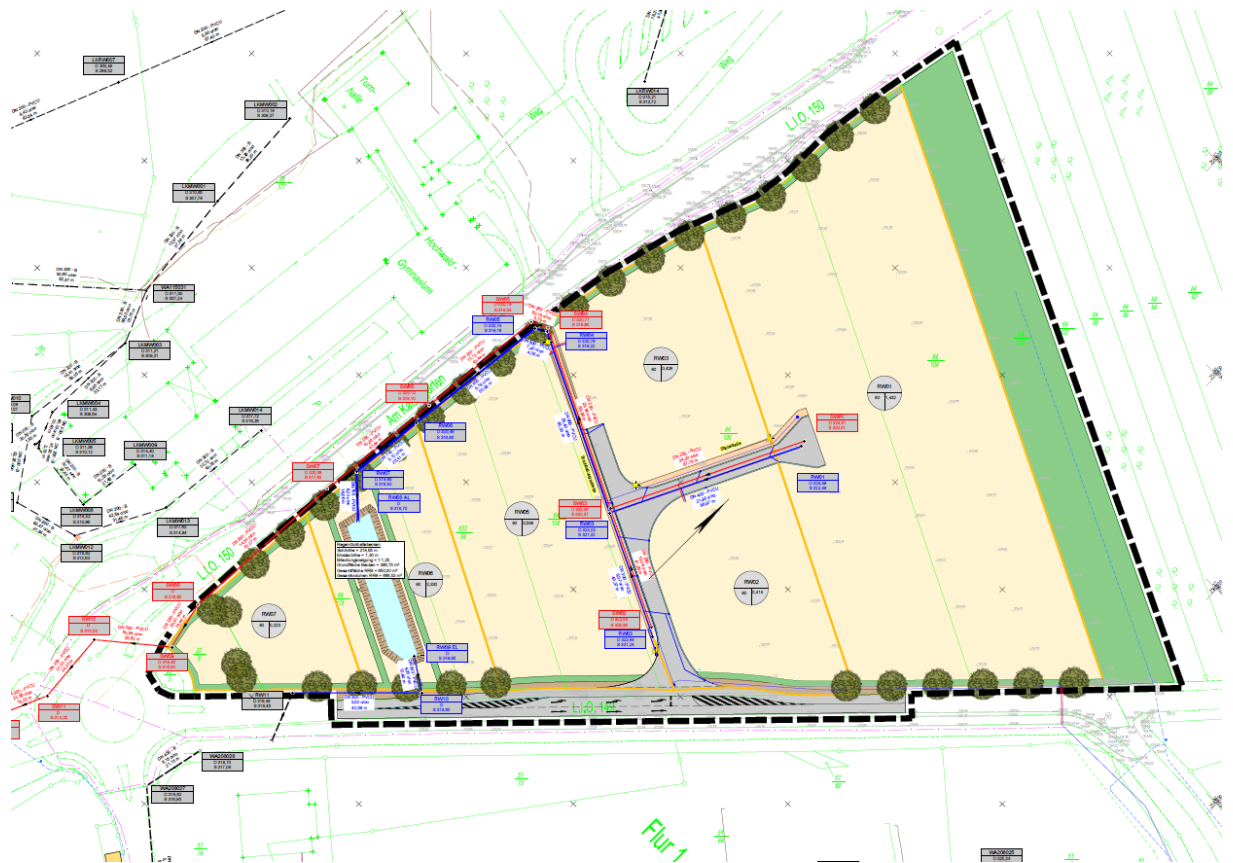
Lageplan Kanal, o.M. (Quelle: Machbarkeitsstudie, P & P GmbH).
